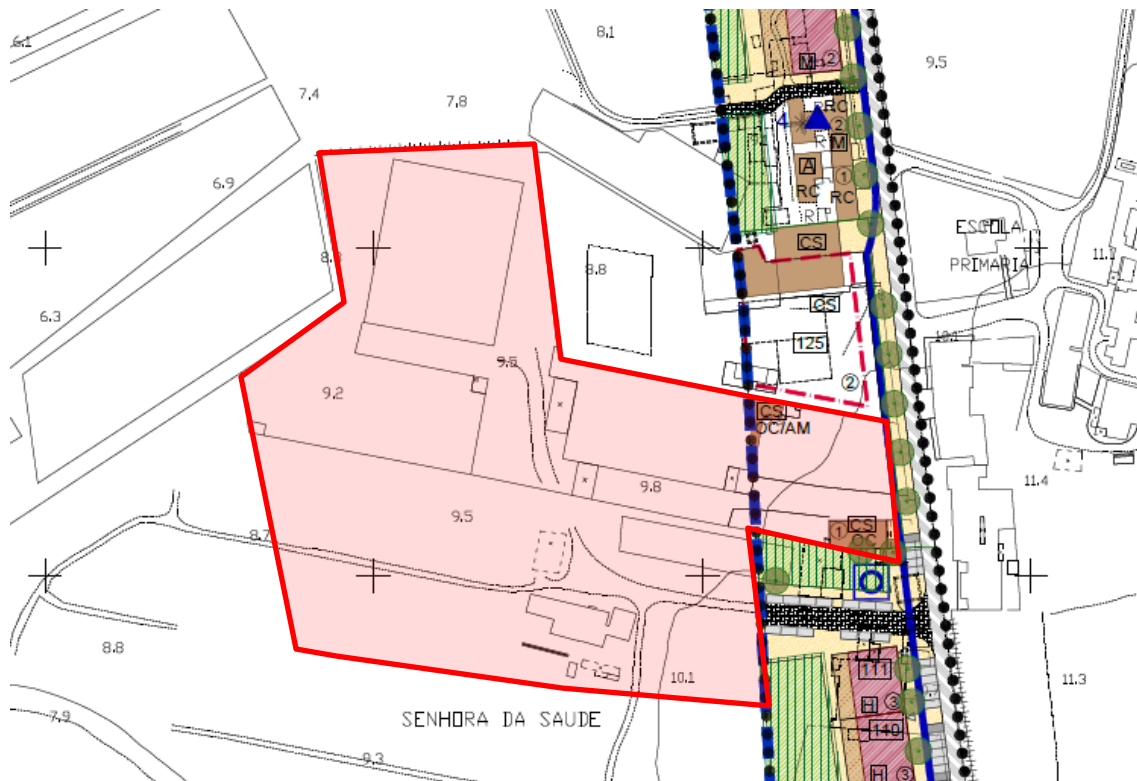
Extrato da planta de implantação do PPSMVPM com localização da Auto Salvados do Algarve II
